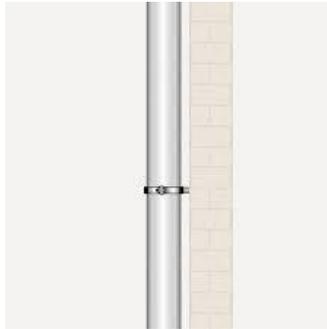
Anclaje de una tubería bajante (Fuente: <http://www.generadordeprecios.info/#gsc.tab=0>)
